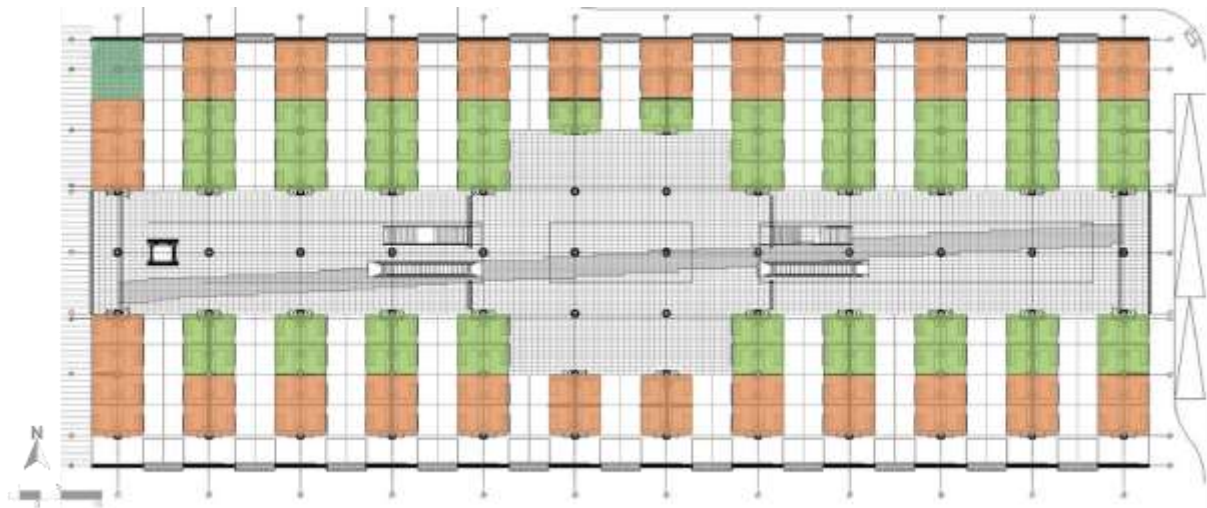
Zonificación Planta Baja, Fuente: Iglesias Pratt (2011), Elaboración Propia.
